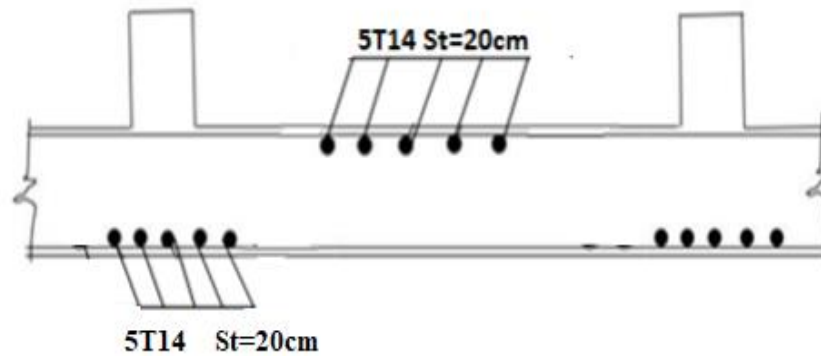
Schéma de ferrailage de la dalle du radier (sens yy).
